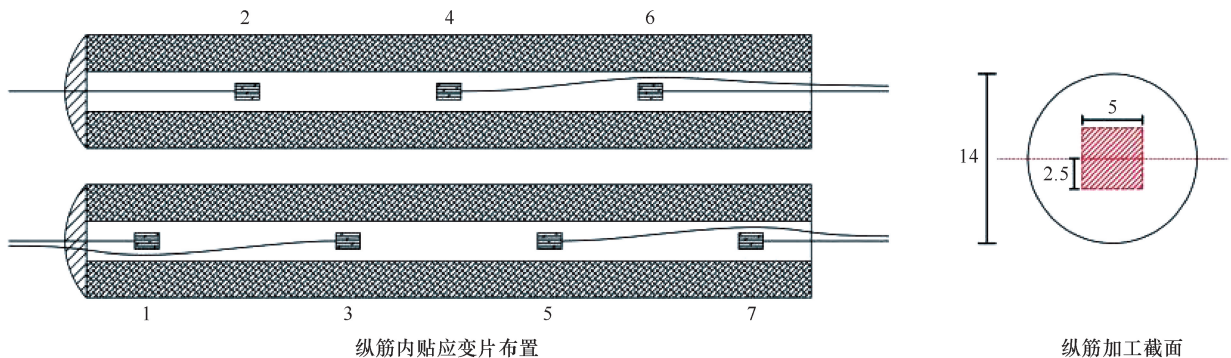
主拉纵筋剖面加工处理与内贴应变片布置(单位: mm)
